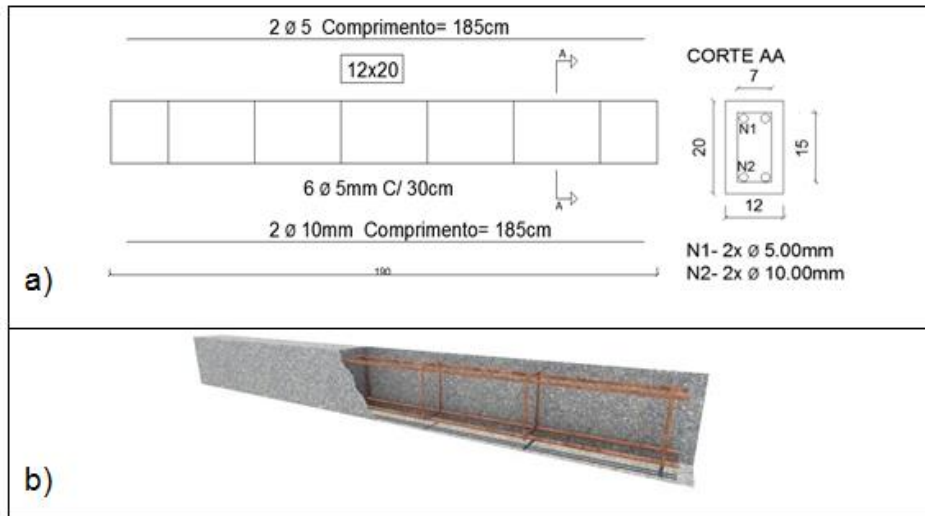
Detalhamento das armaduras nas vigas: (a) Detalhamento longitudinal (b) Perspectiva da armação. (Fonte: LOPES, 2017)
